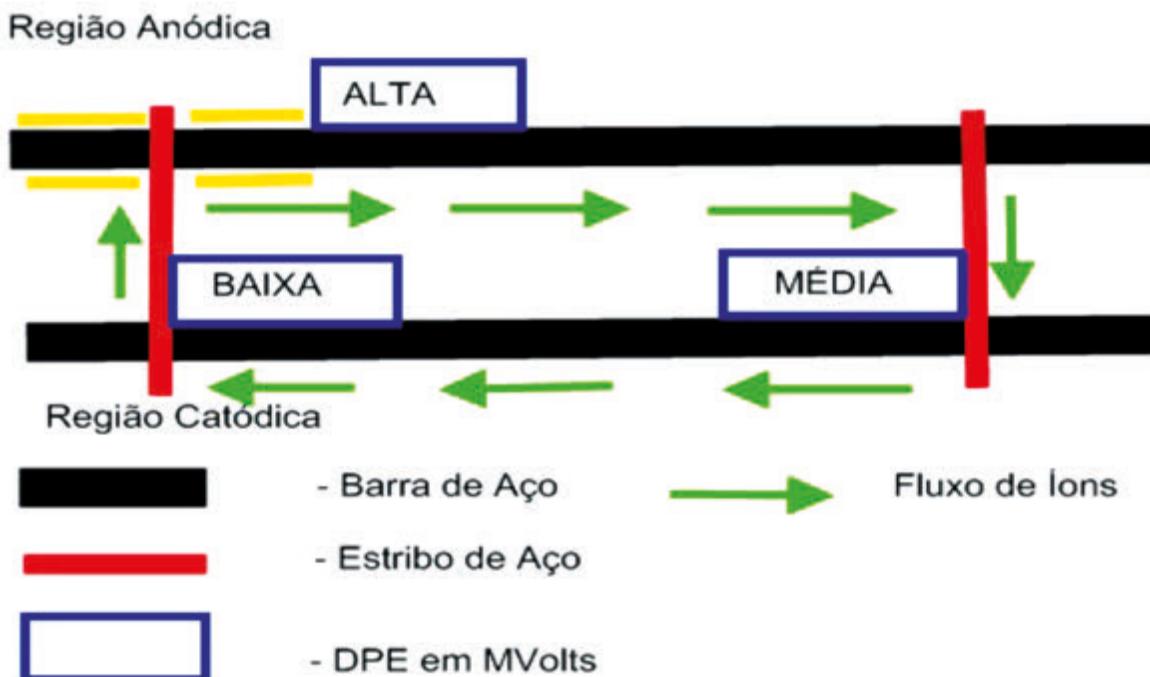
Situação de corrosão em Concreto Armado (Antes do Reparo - RE).
